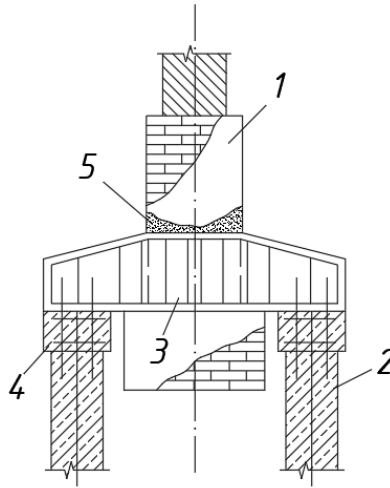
Підсилення стрічкового фундаменту на природній основі палями з улаштуванням рамної системи: 1 - посилений фундамент; 2 – палі підсилення; 3 - залізобетонний ригель; 4 - залізобетонна подушка; 5 - омонолічування пробитих під ригель отворів
